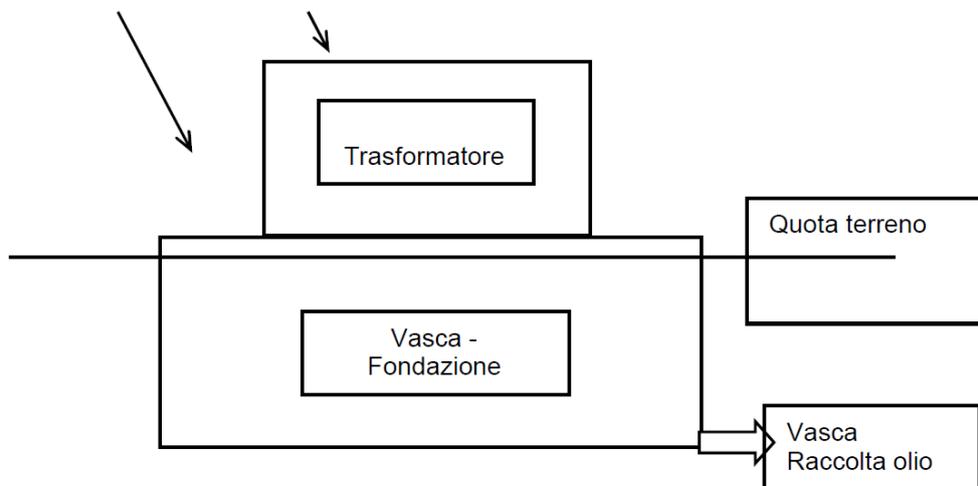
SCHEMA DELLA FUNZIONE VASCA FONDAZIONE
